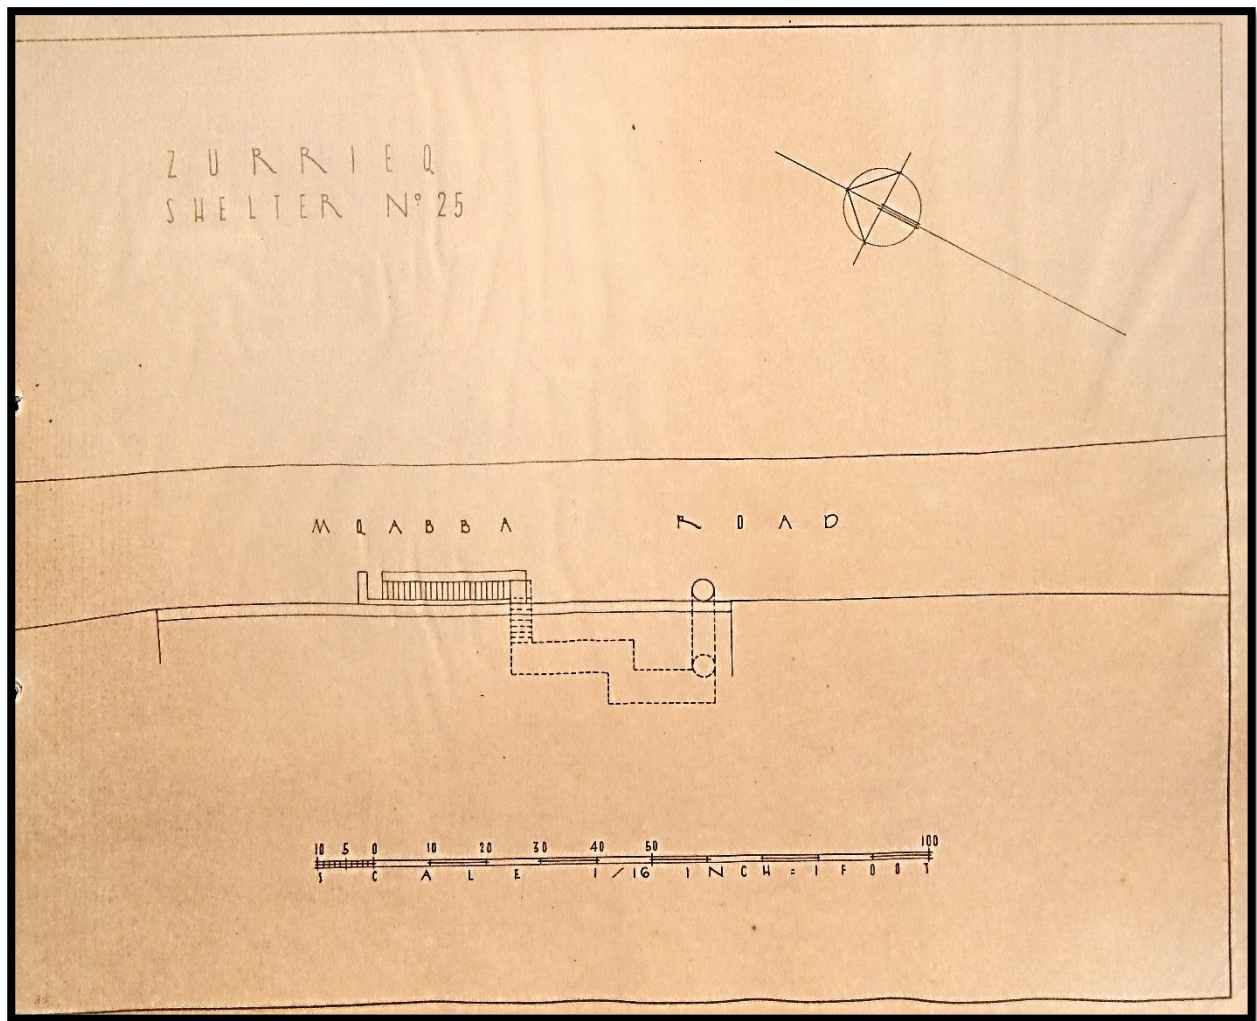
Planta do Abrigo nº25 "Mrabba Road"
